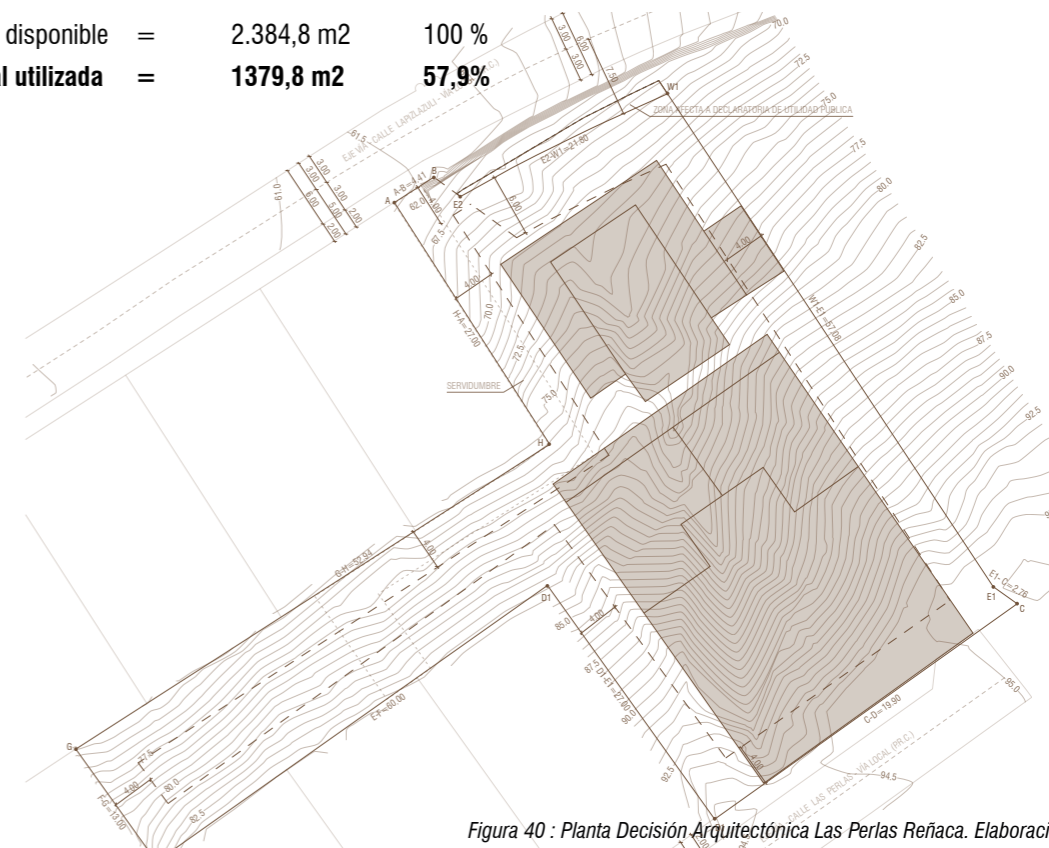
Planta Decisión Arquitectónica Las Perlas Reñaca. Elaboración propia.
